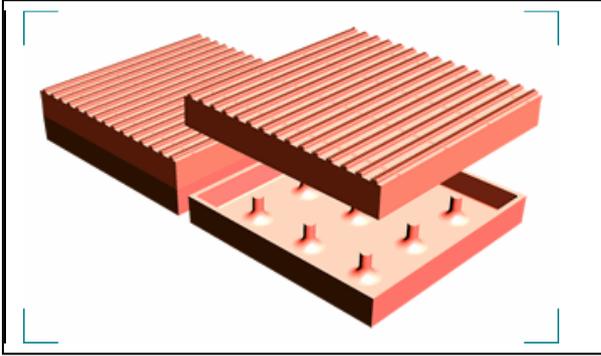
Kunststoff-Schachtdeckel – mit dem Blindenstock eindeutig wahrnehmbar, aber zu kostspieliger Einbau.
